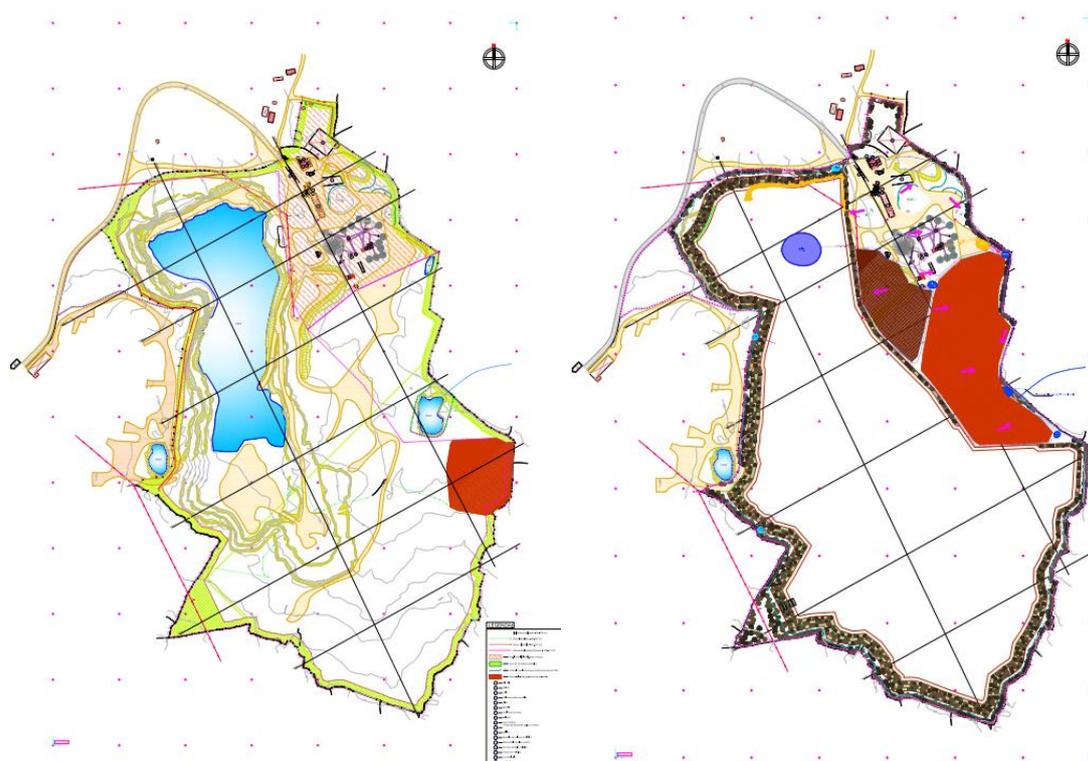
Planta da situação inicial à esquerda e planta da situação final à direita - Fonte: Plantas e Perfis_EIA
